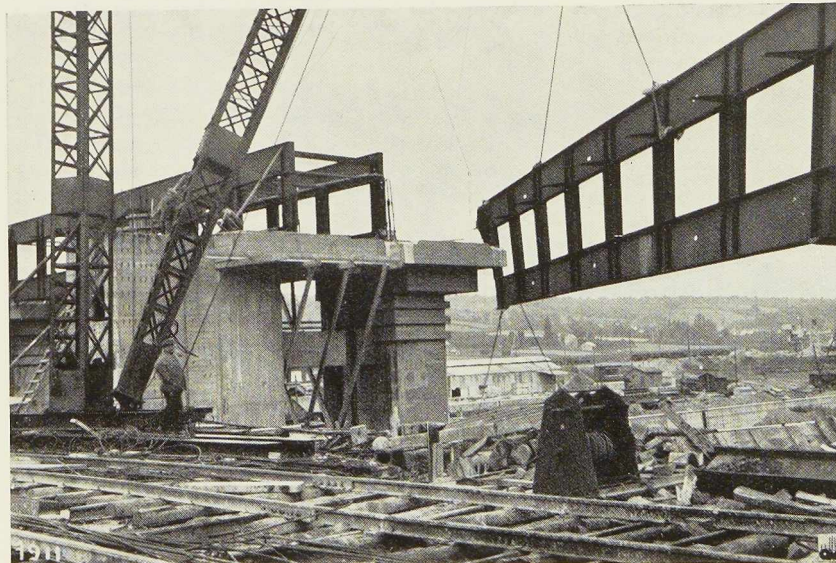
Montage d'une poutre Vierendeel de la passerelle.
